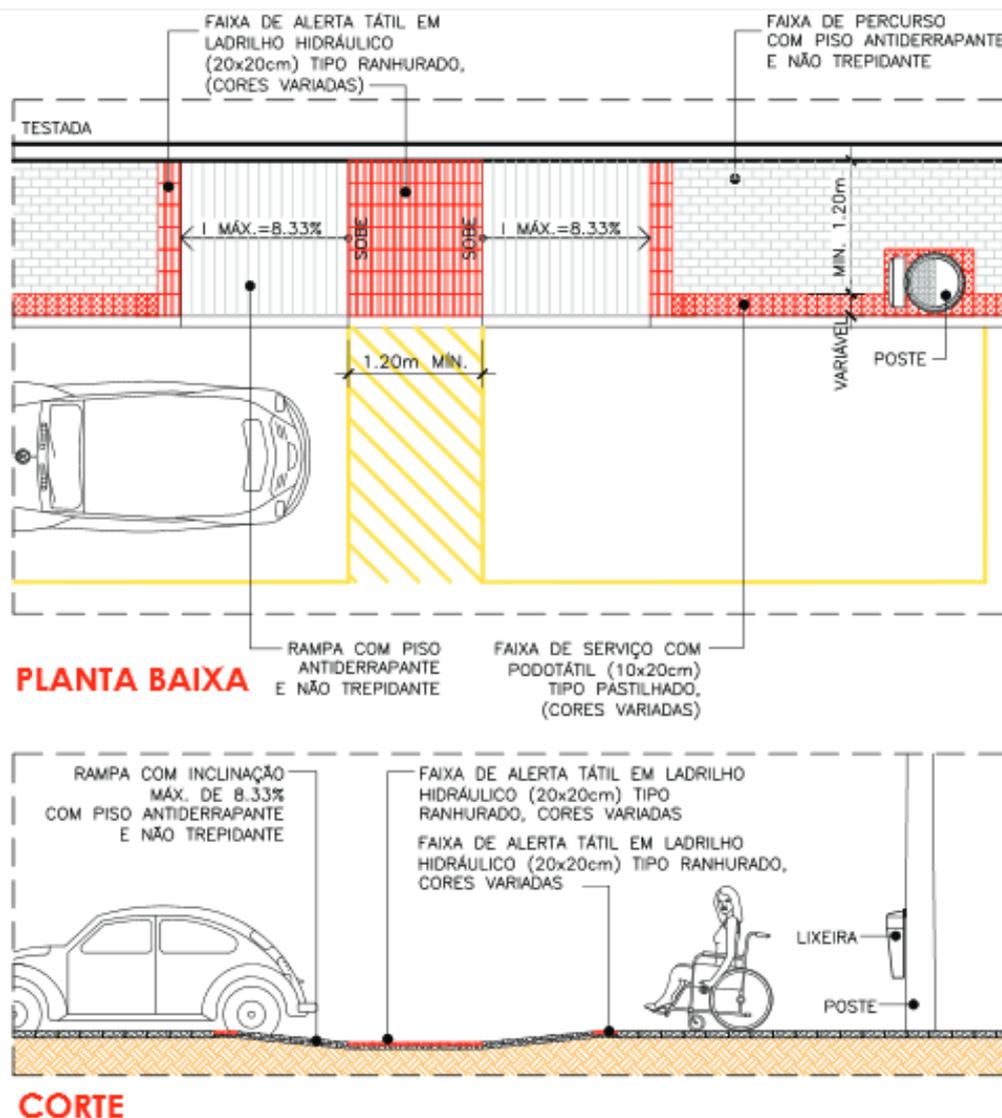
Planta baixa e corte de modelo de rampas para pedestres.
